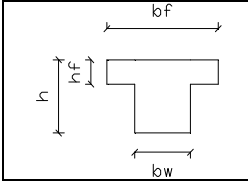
Elementos-macro para as vigas da modelação.
